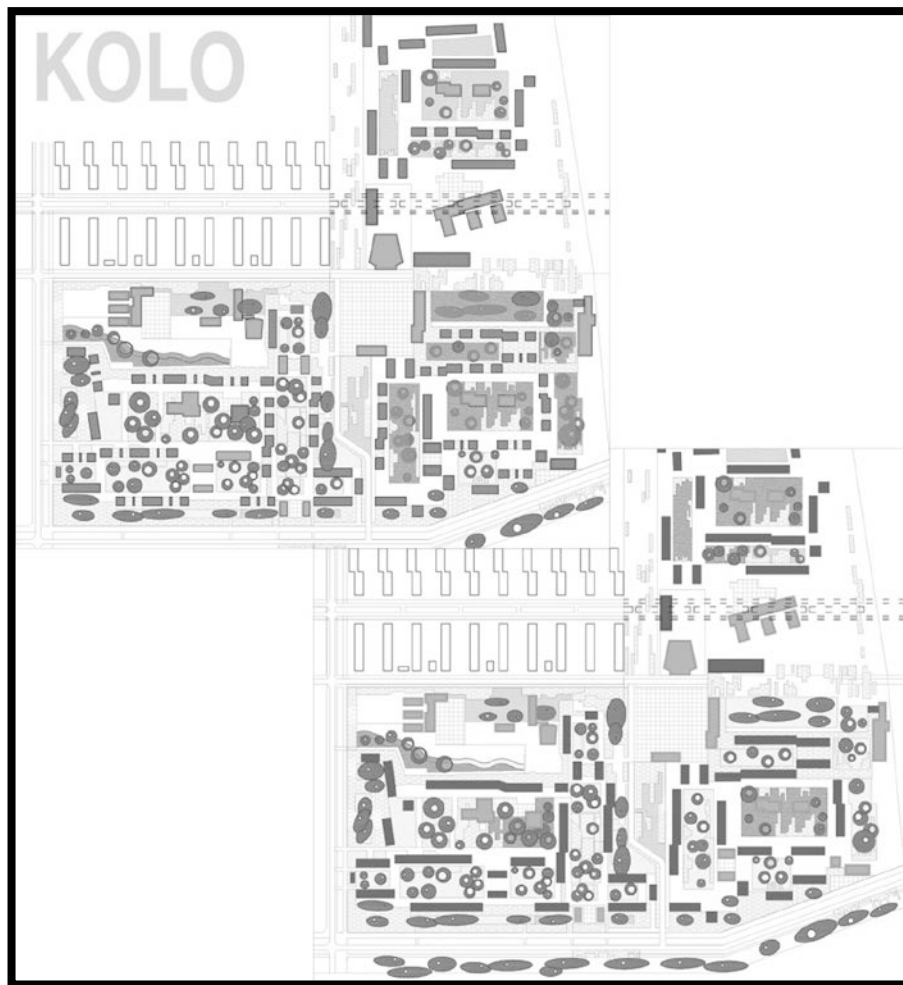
Planta nivel suelo y planta de cubierta. Osiedle Kolo (Elaboración propia)
